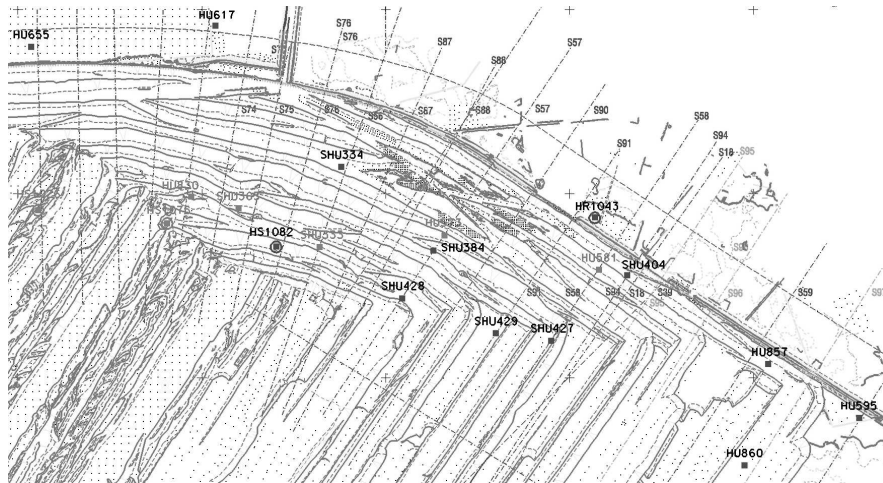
Grundrissliche Darstellung einer Randböschung mit Schnittlagen für geomechanische Berechnungen
